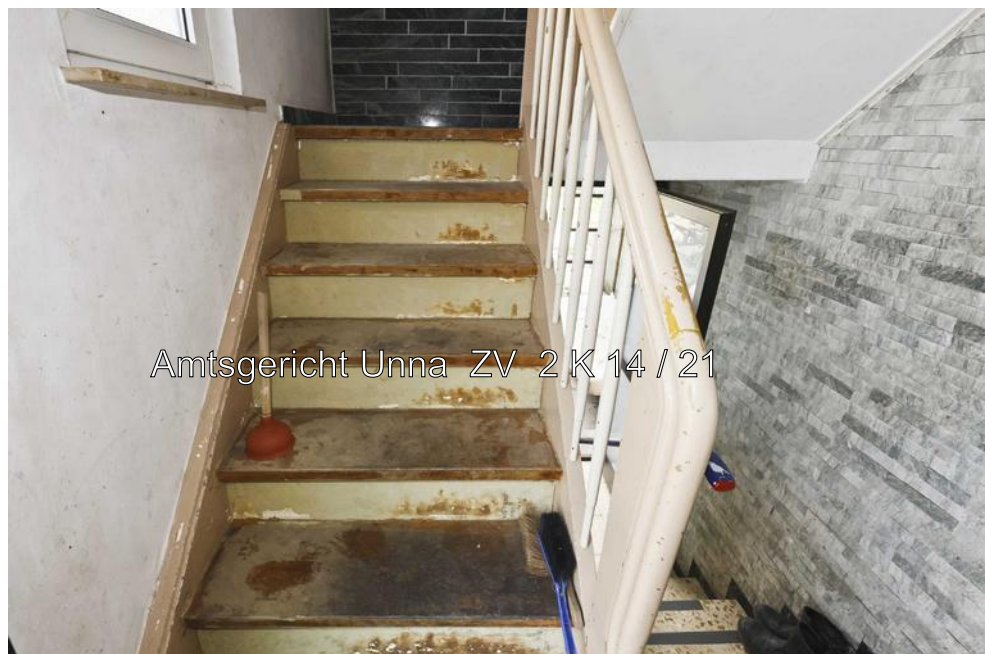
EG: Treppe zum Dachgeschoss
